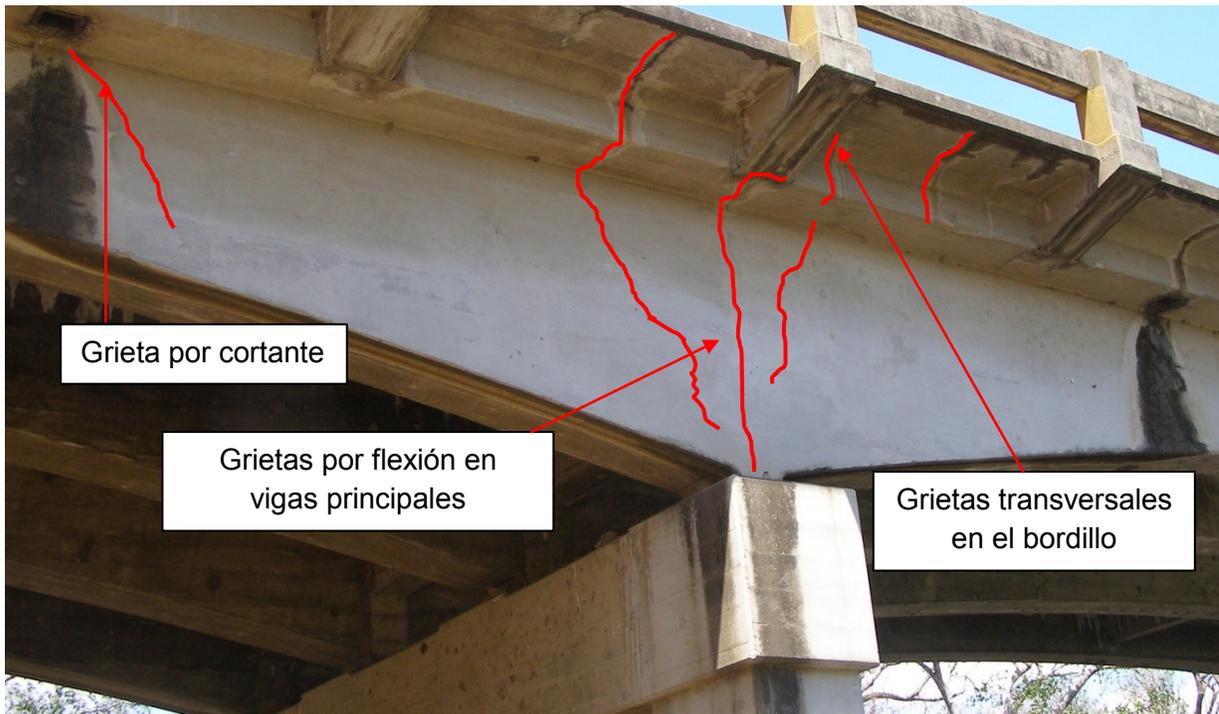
Agrietamiento transversal del bordillo de seguridad coincidente con las grietas por flexión en las vigas principales en la zona cercana a la pila 1.
